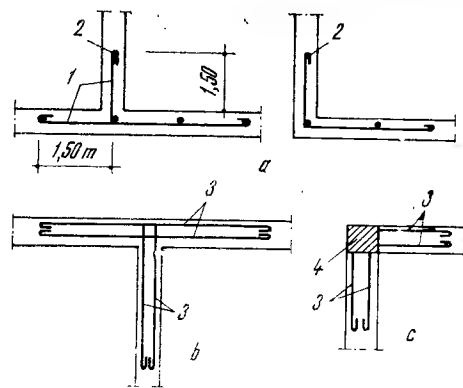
Legături la pereți din zidărie: a - cu legături orizontale și verticale din oțel-beton; b - cu armături transversale; c - cu simbur de beton armat și armături transversale; 1 - armături orizontale; 2 - armături verticale; 3 - armături transversale; 4 - simbur din beton armat.
